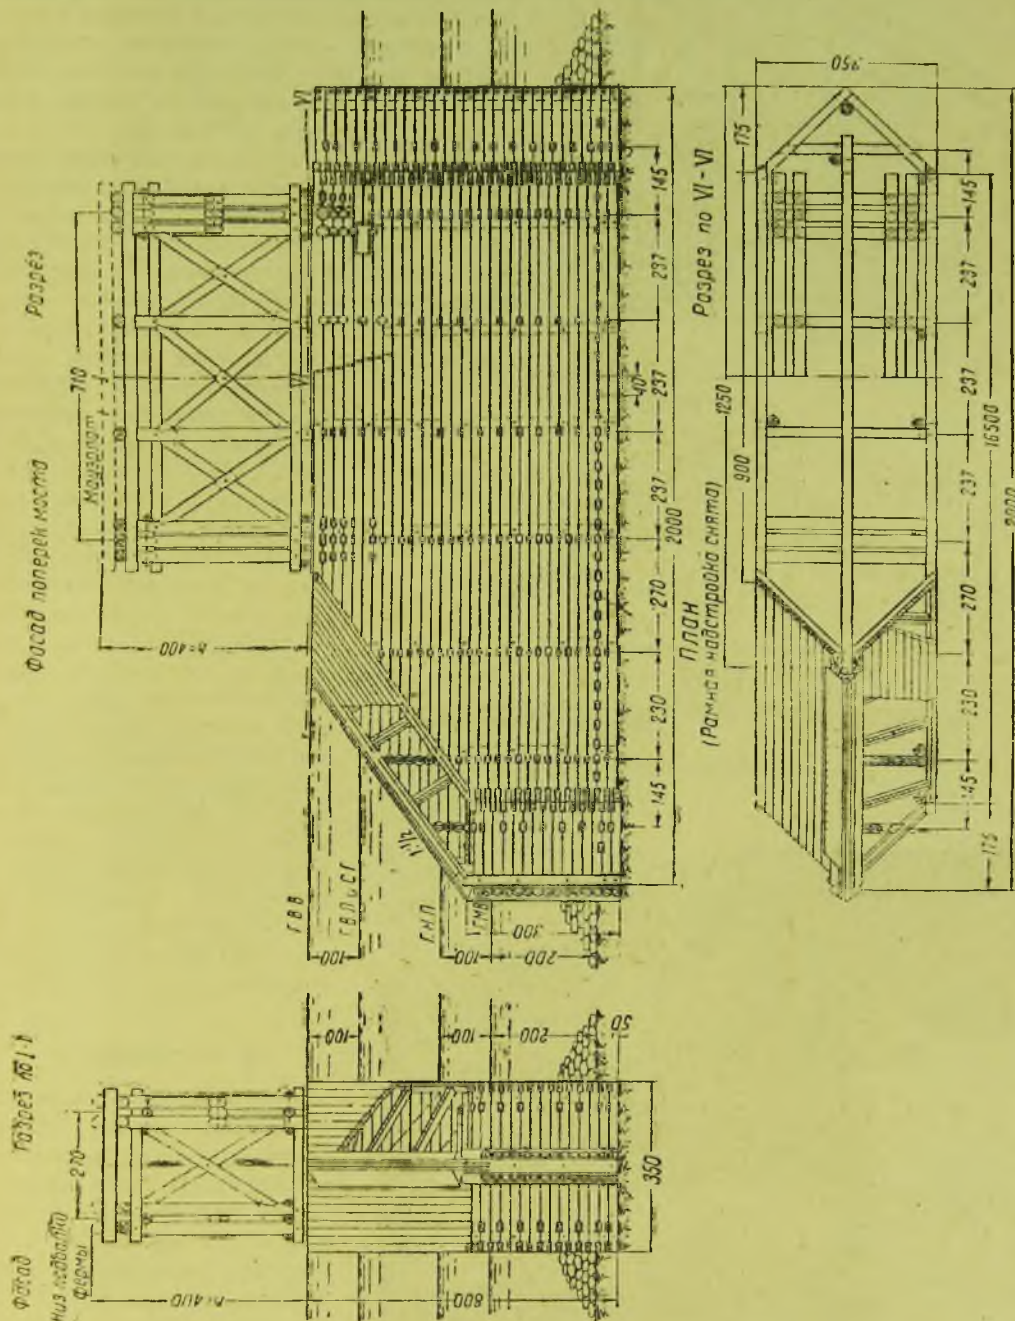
Ряжевая опора с рамной надстройкой под пролетное строение с ездой поверху.
